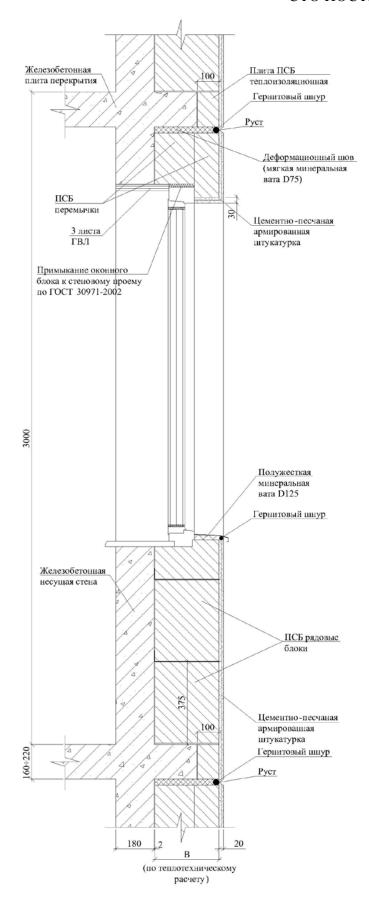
Несущая железобетонная стена, утепляемая ПСБ изделиями, с наружной цементно-песчаной облицовкой. Вертикальный разрез по оконному проему
